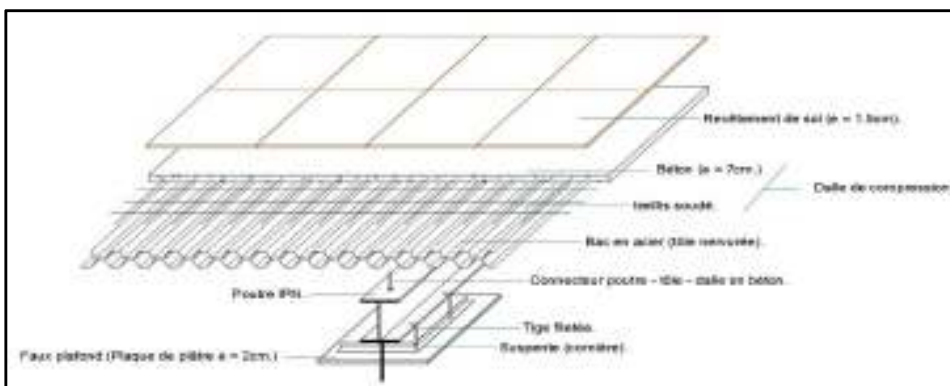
Détails plancher de type collaborant .Source : [http : //www.archistructur.org](http://www.archistructur.org)
